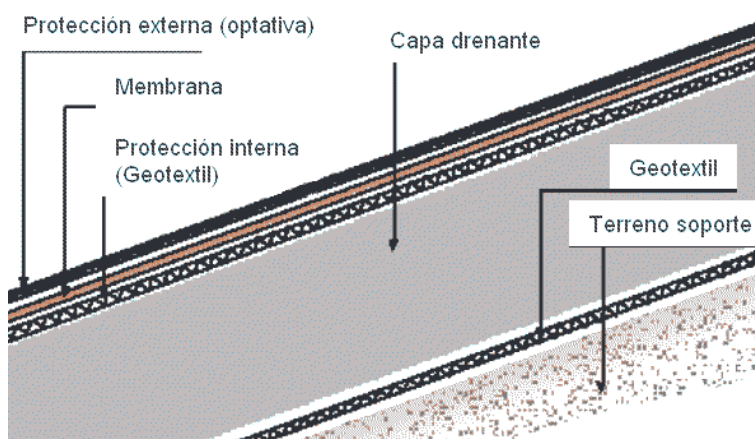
Elementos de una pantalla de impermeabilización. Fuente: (ALKORPLAN. 2004)
